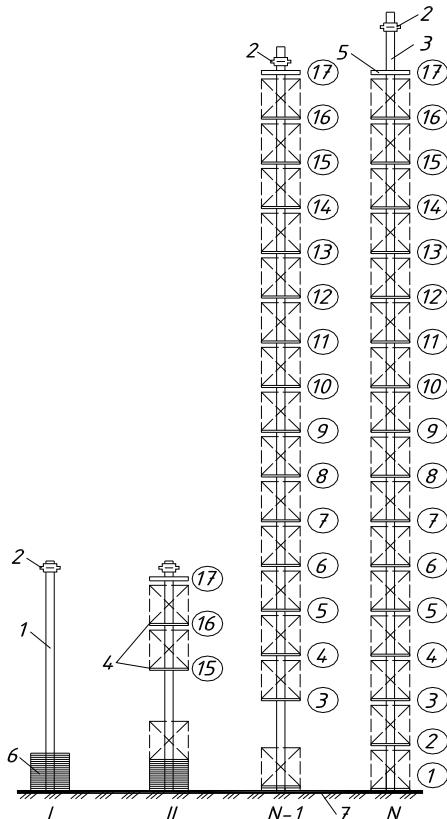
Схема монтажа зданий методом последовательного подъема этажей:
